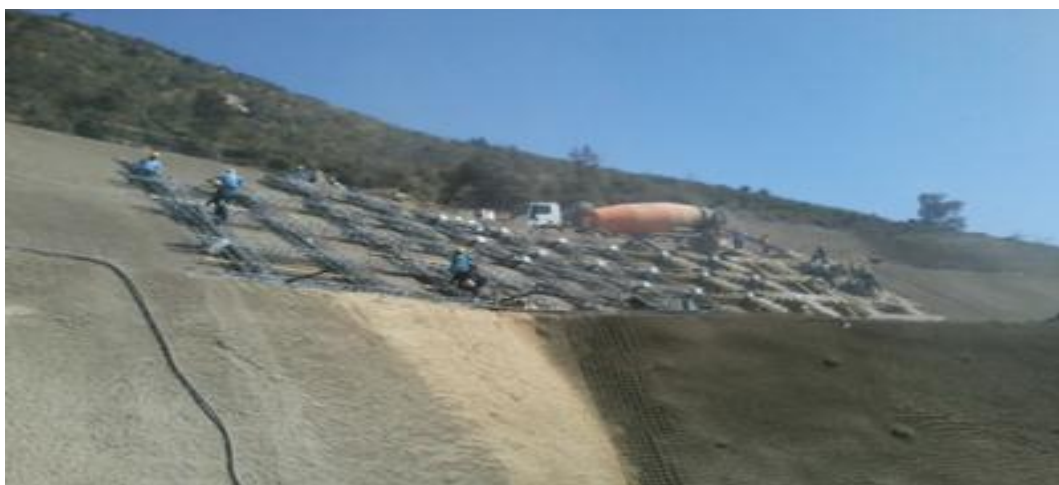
poutres entrecroisées sur un talus de portail d'un tunnel.
